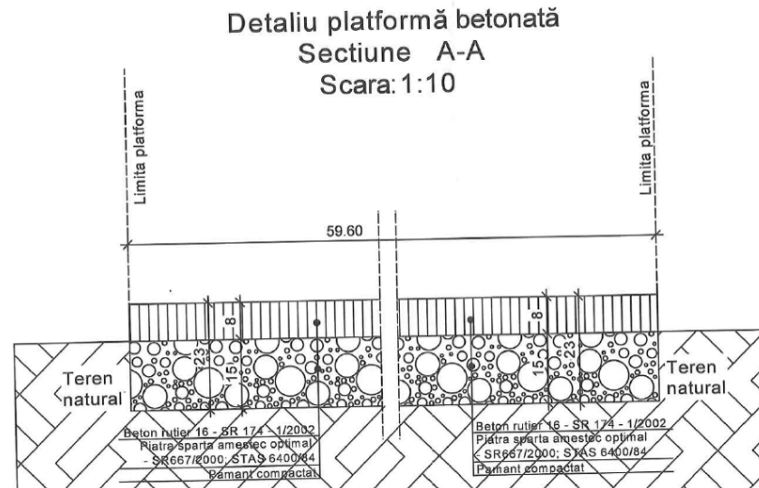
Detaliu platforma betonata (extras Plan de situatie si detalii alei/platforme betonate si imprejurimi)
